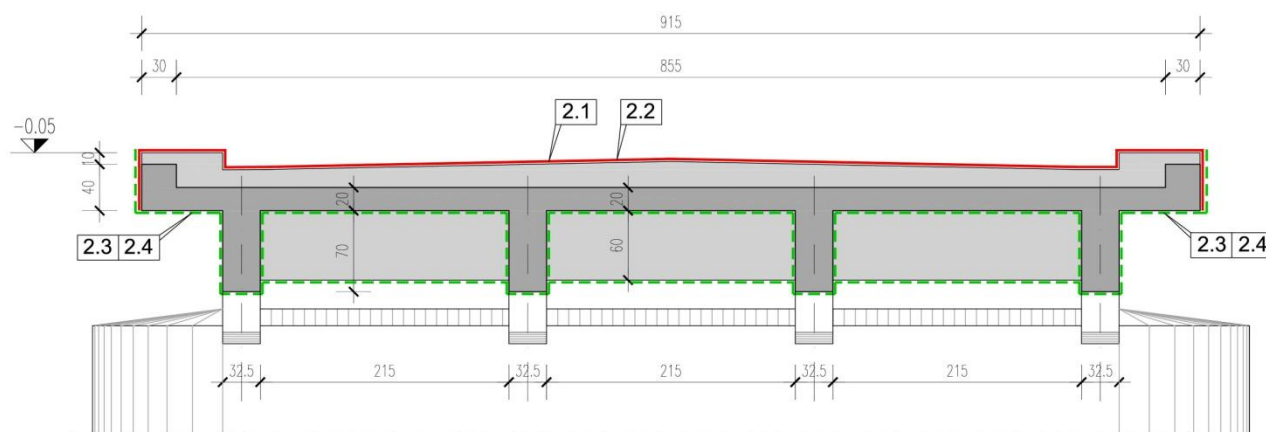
Sezione tipologica impalcato - fase di impermeabilizzazione
